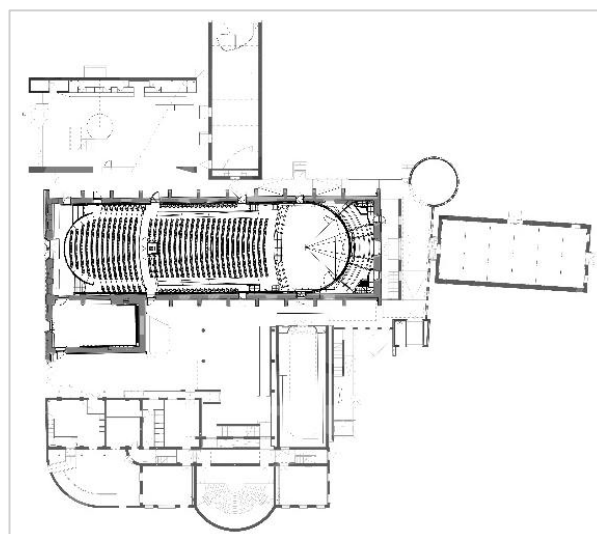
Planta del centro de conciertos de Bijlok. Fuente: archivo cad proporcionado administración Bijloke.
